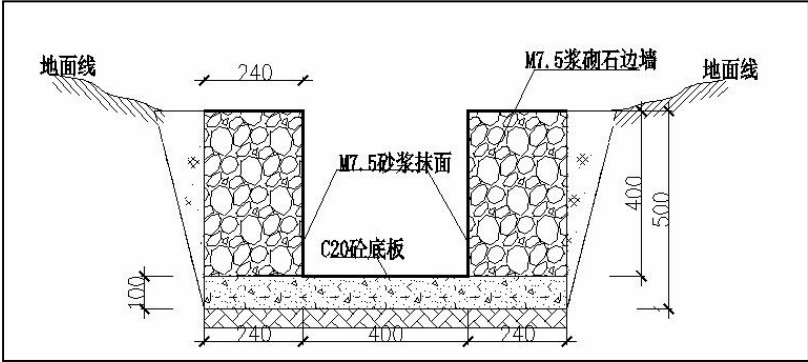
截排水沟（0.4*0.4m）截面设计示意图（单位：m）
